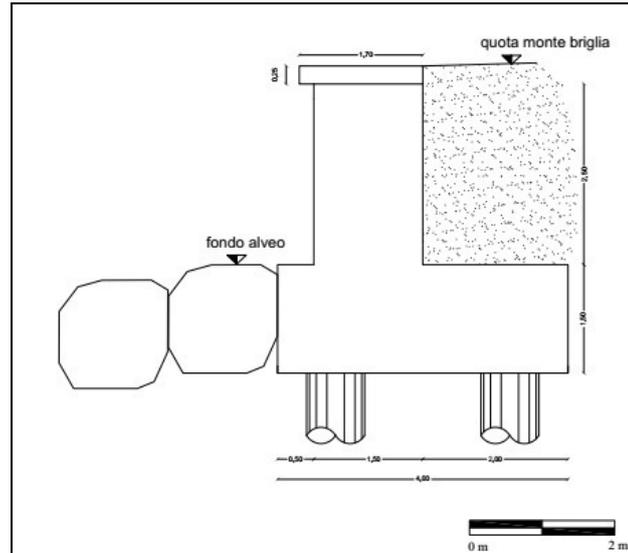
sezione tipo della briglia fondata su pali trivellati
